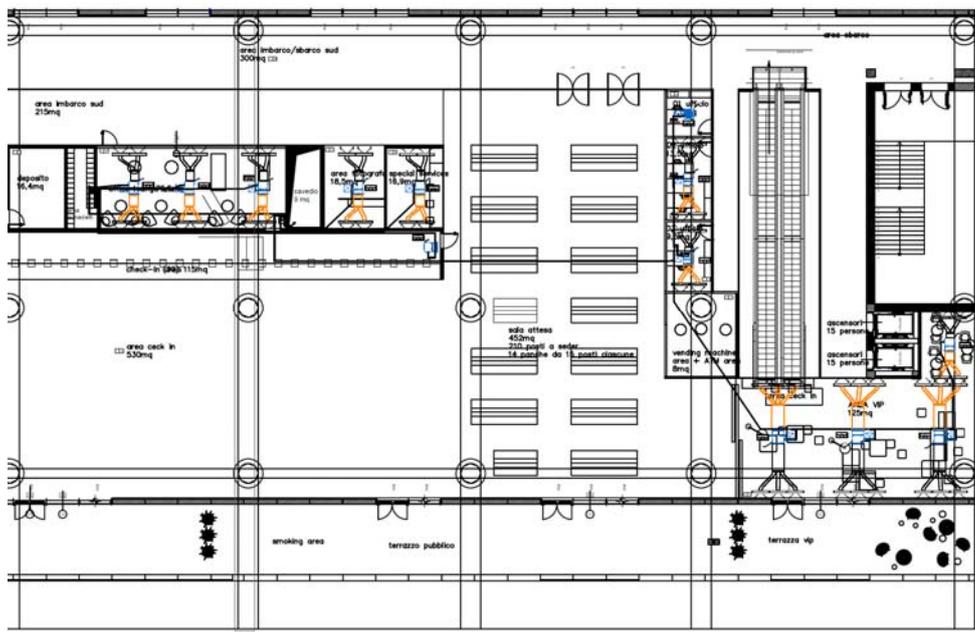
Edificio terminal, piano primo lato sud: disposizione dei Fancoil, indicazione macchina e passaggio delle tubazioni
